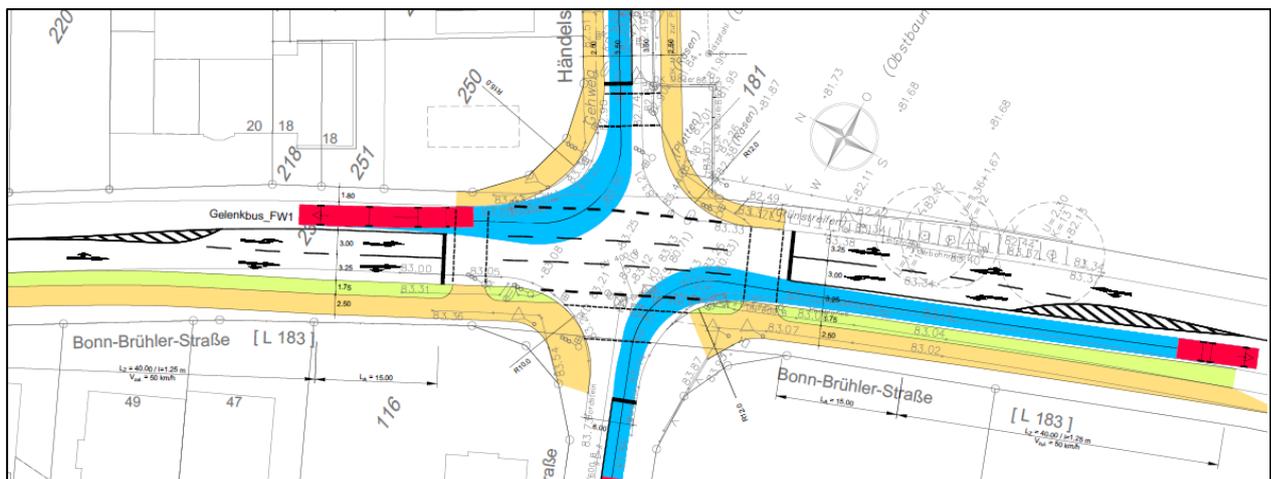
Lageplan mit Einpassung Linksabbiegefahrstreifen im Zuge der L 183
